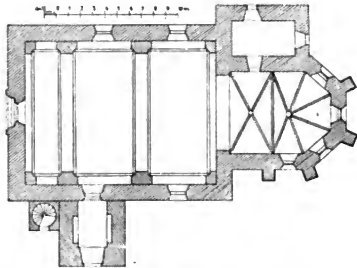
Hodušín. Grundriss der Kirche.
